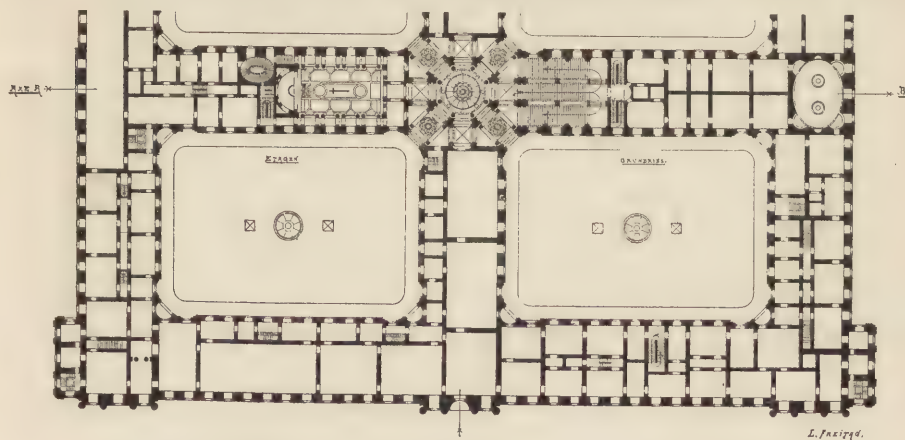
Schloss Caserta. Grundriss des Hauptgeschosses.
